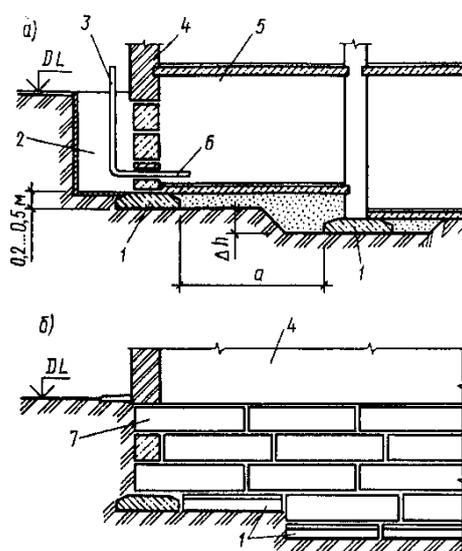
Выбор глубины заложения фундамента в зависимости от конструктивных особенностей сооружения: а – здание с подвалом в разных уровнях и прямком; б – изменение глубины заложения ленточного фундамента; 1 – фундаментные плиты; 2 – прямок; 3 – трубопровод; 4 – стена здания; 5 – подвал; 6 – ввод трубопровода; 7 – стеновые блоки
